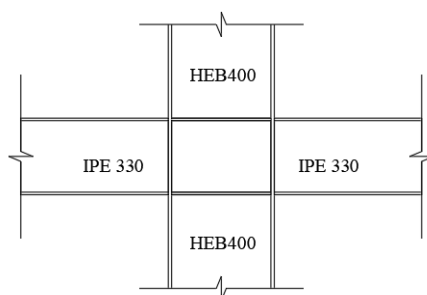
Conexión RBS Columna B2 Piso 4.
